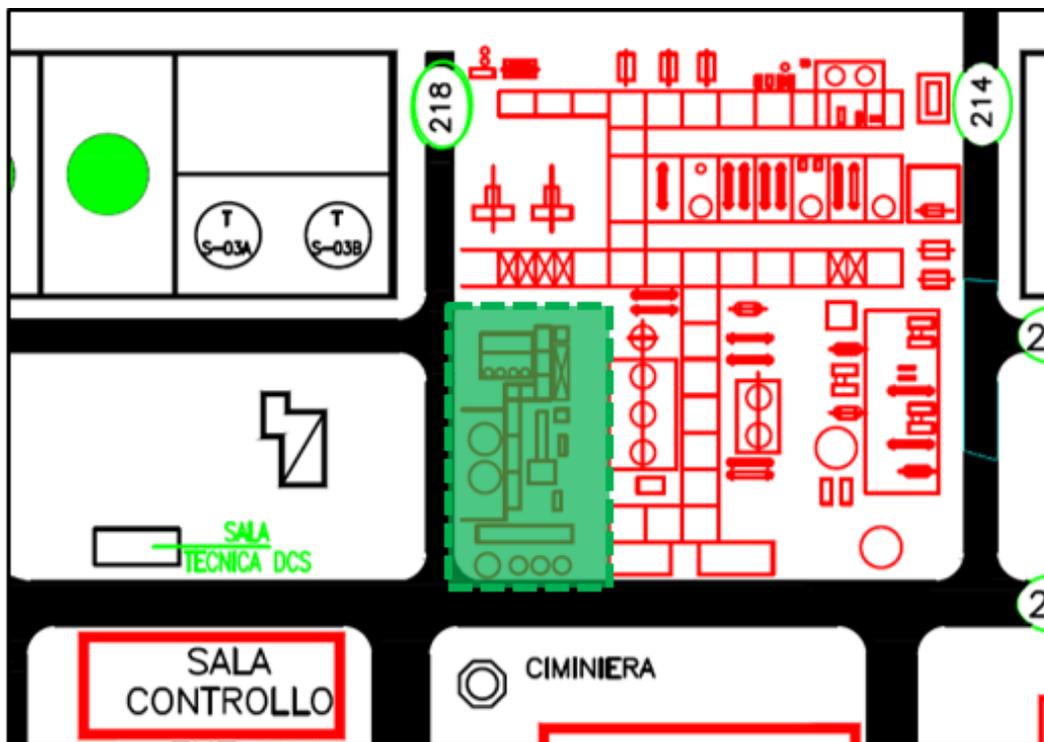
Dettaglio dell'Unità 9400. In verde le aree della Raffineria oggetto di modifica nell'ambito dell'Unità 9400 (Fonte: Documentazione di progetto Eni)
